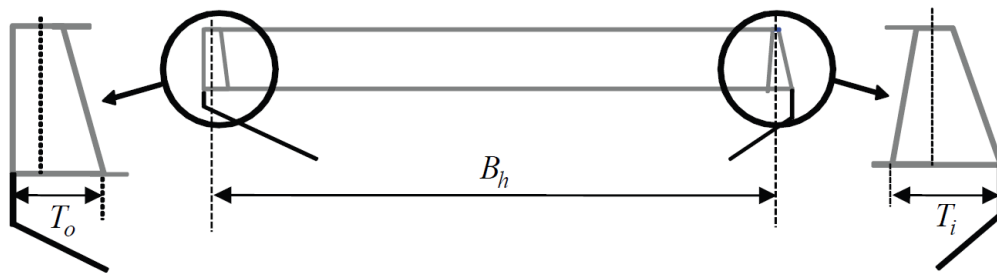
Detalles de las secciones transversales de las crestas del PKW
